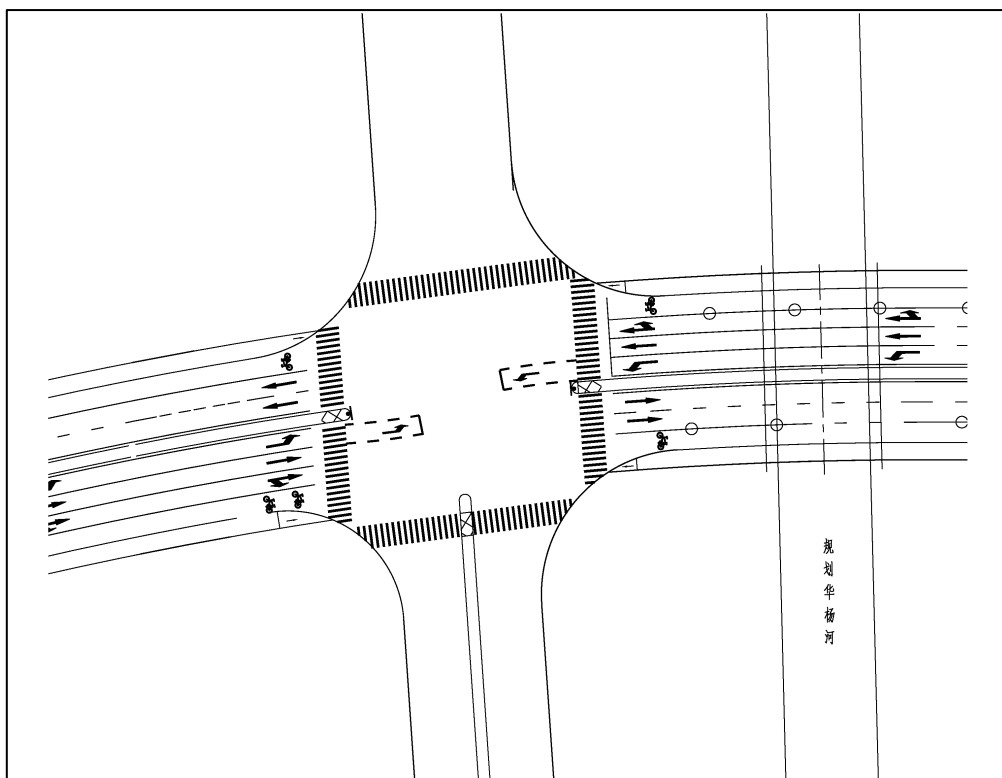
本项目与 G312 交叉口平面图（含规划华杨河）
